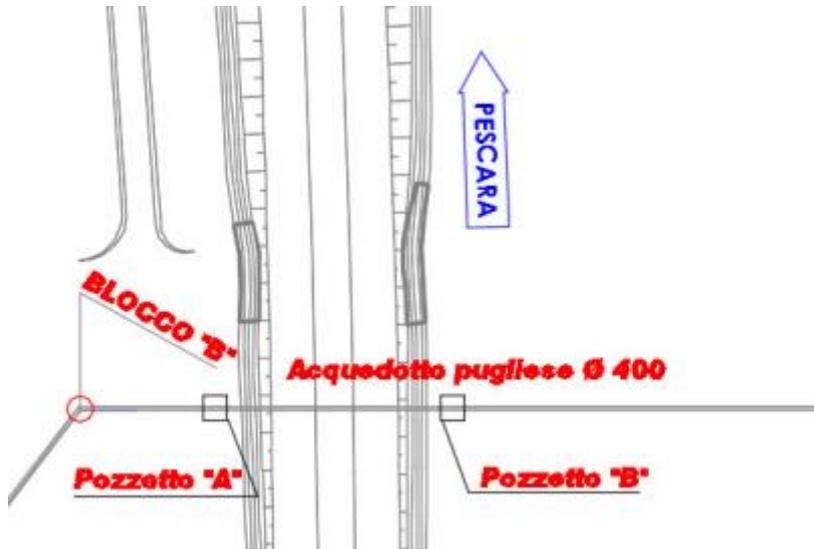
Stralcio planimetrico con indicazione dei pozzetti in progetto.
